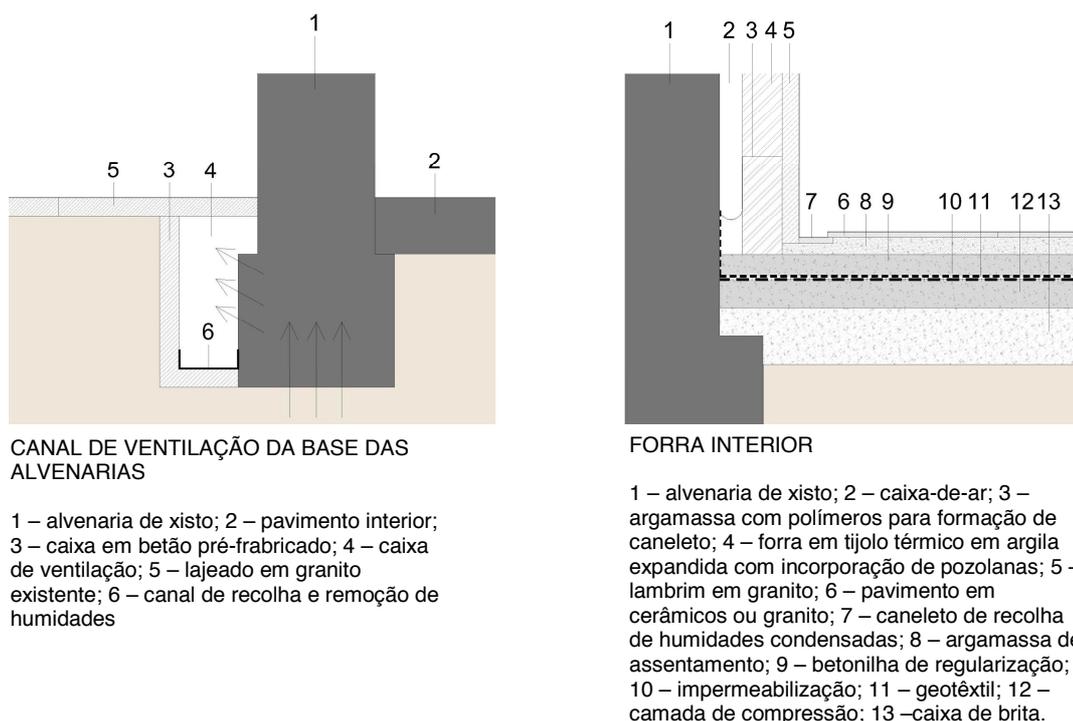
Pormenor construtivo do canal de ventilação das alvenarias estruturais e da forra interior em tijolo térmico
